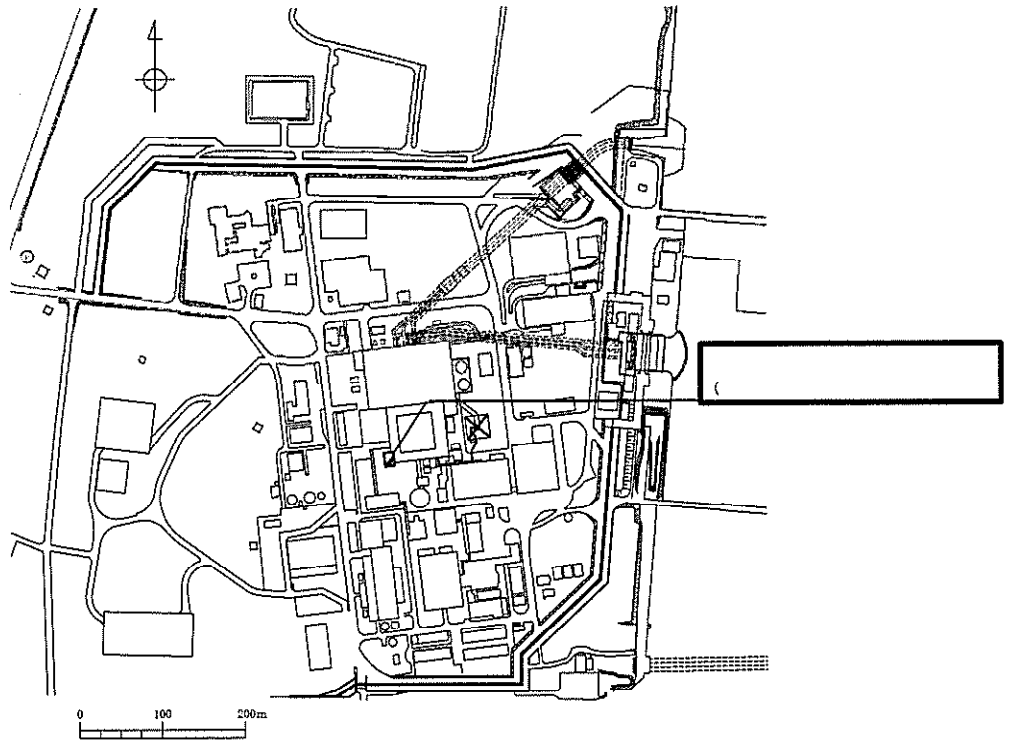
(1) カルバートの平面配置図（全体平面図）
